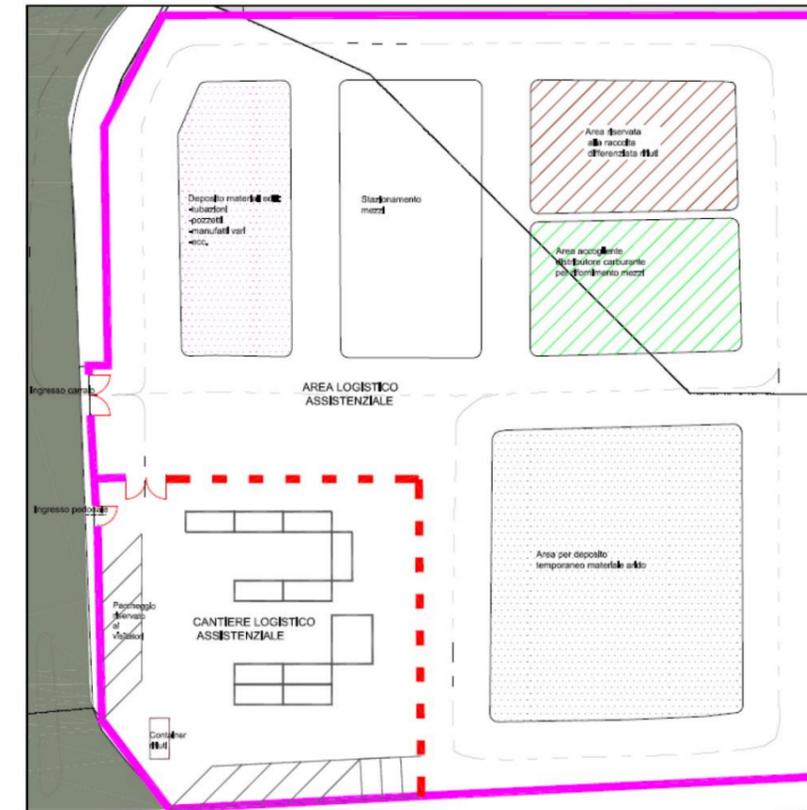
Schema tipo del cantiere logistico – Fase 1 PSA.
